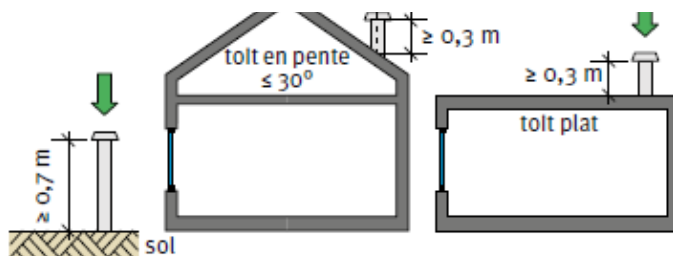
Hauteur minimale des prises d'air placées au sol (à gauche) et sur une toiture dont la pente n'est pas supérieure à 30° (à droite).
